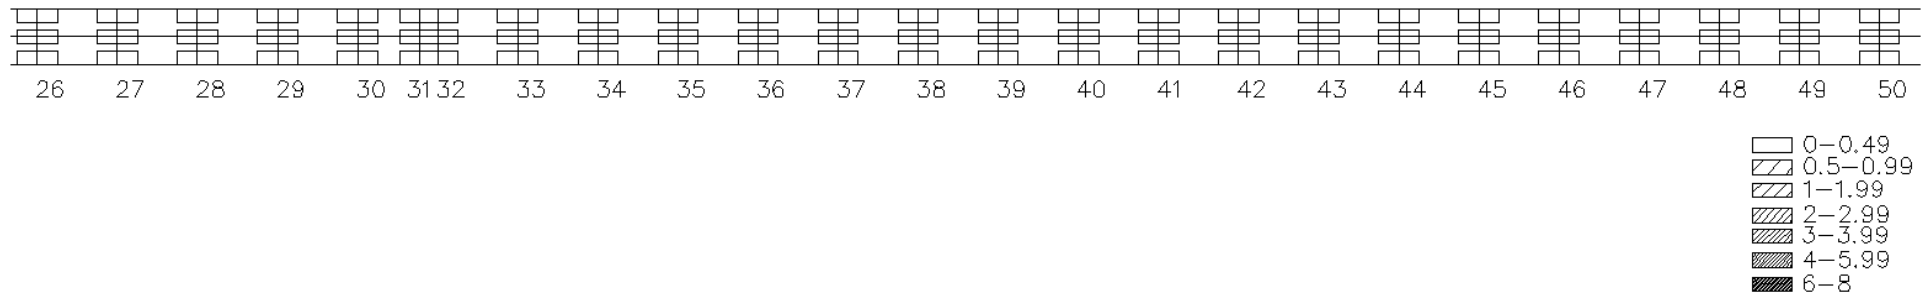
Frästiefen bei Tangenten und quadratischen Parabeln und Verfahrensplan Typ V, Grundriss, Stationen 26-50
